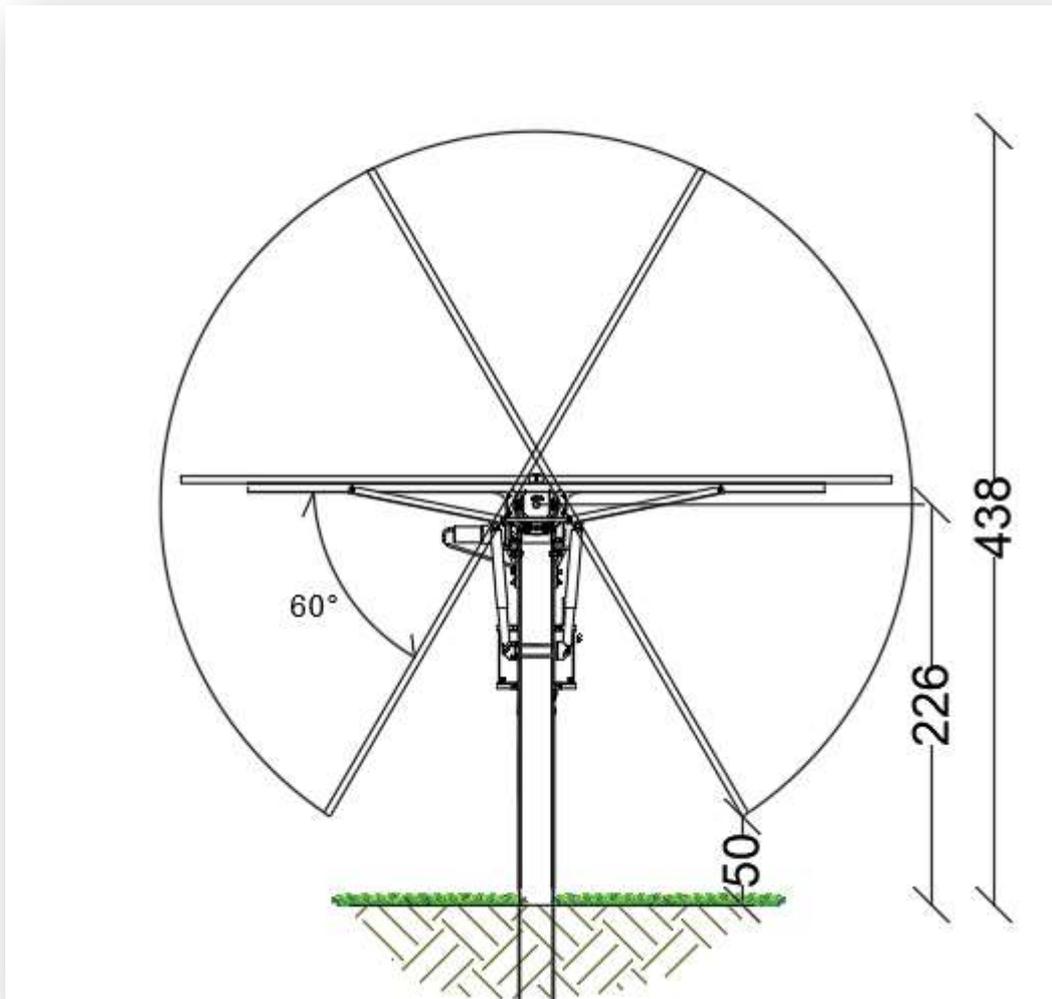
Sezione tipo impianto con installazione su sistema ad inseguimento solare tipo tracker
